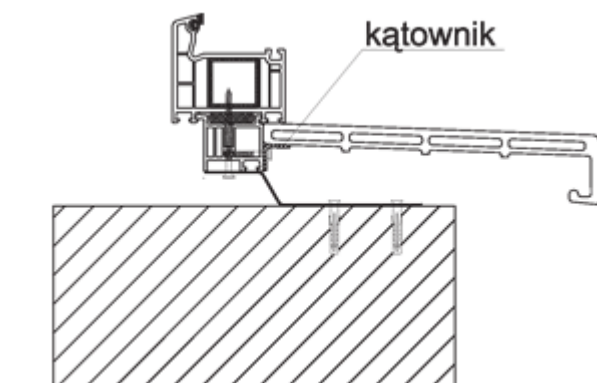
Przykłady zamocowania parapetu zewnętrznego i wewnętrznego do okna z kształtowników aluminiowych
